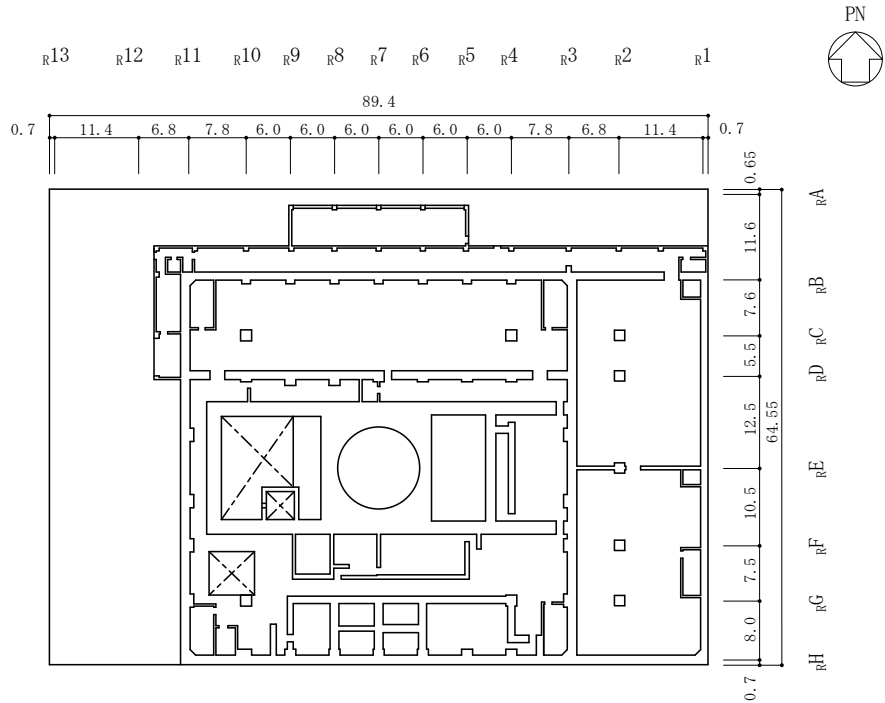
(4) 原子炉建物の概略平面図 (EL 23.8m)
